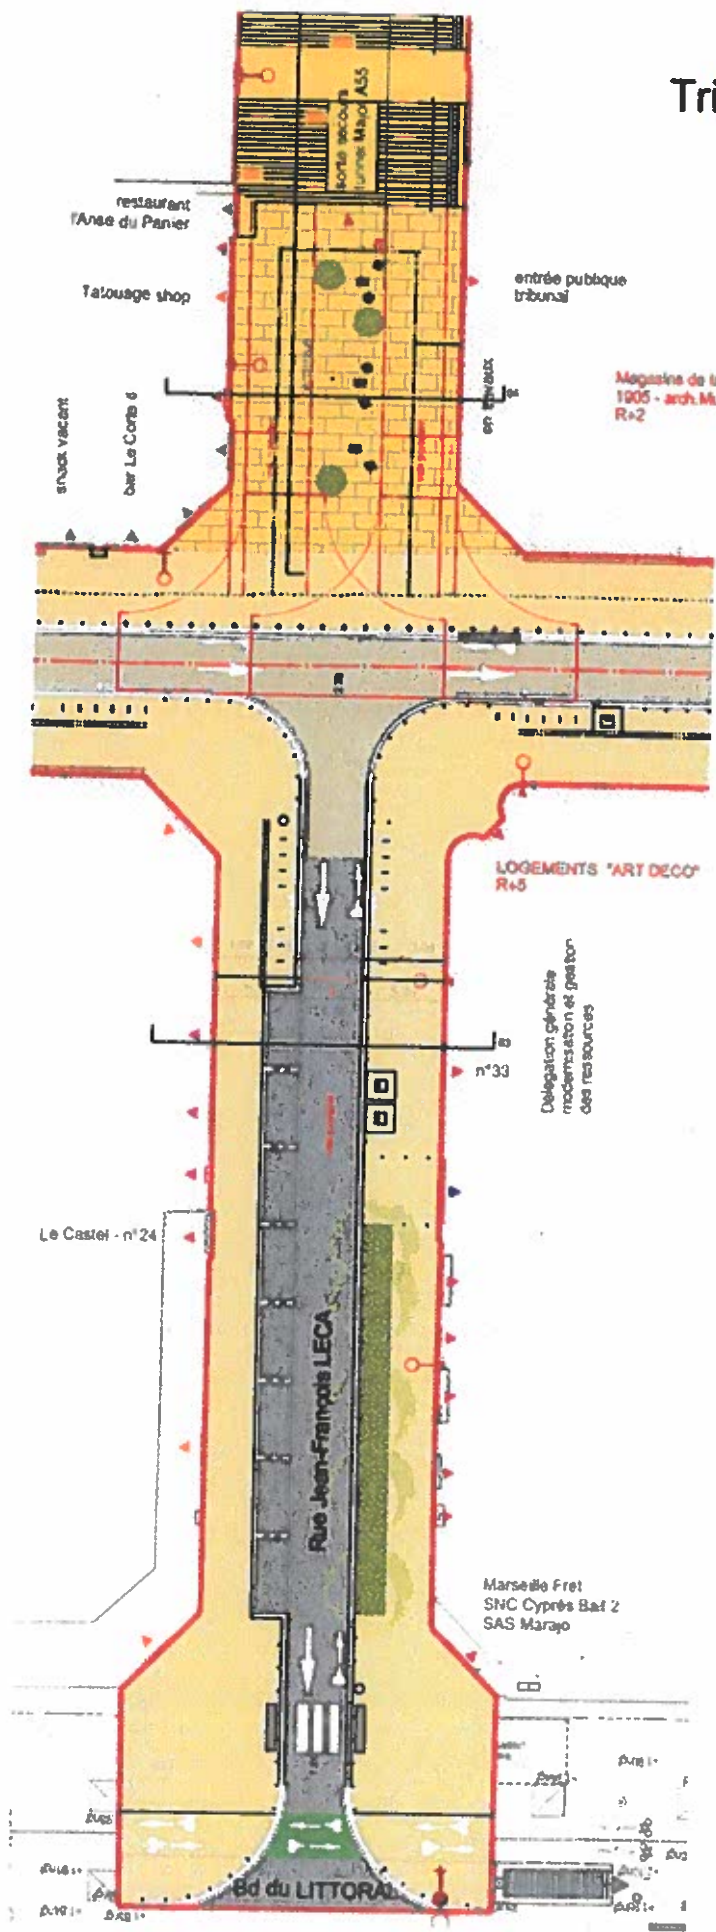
Plan Général des Travaux (4/6) - Section Rue Jean-François LeCa
